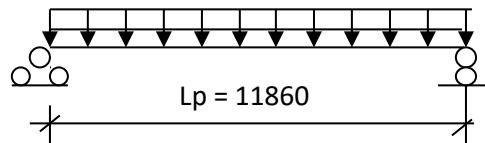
Розрахункова схема подовжнього ребра
